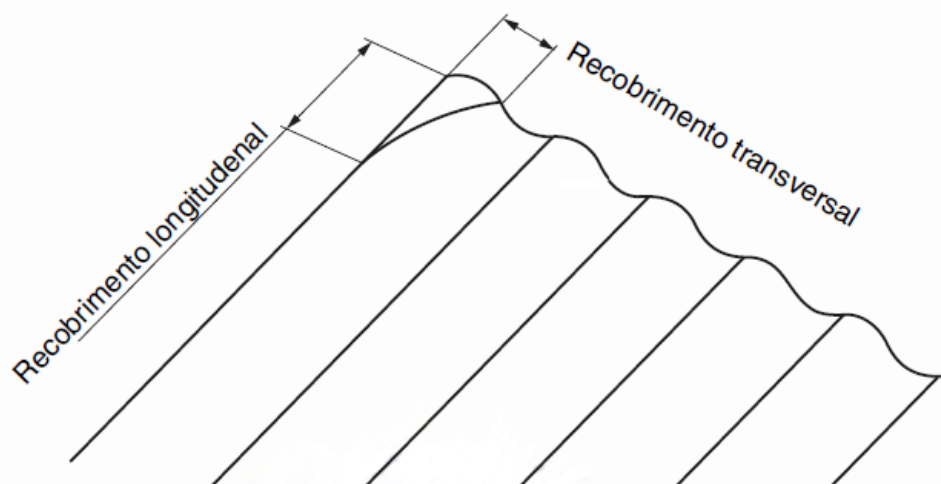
Esquema de recorte de canto para telhas onduladas apresentado na NBR 7196. Fonte: Adaptado de ABNT (2020).
